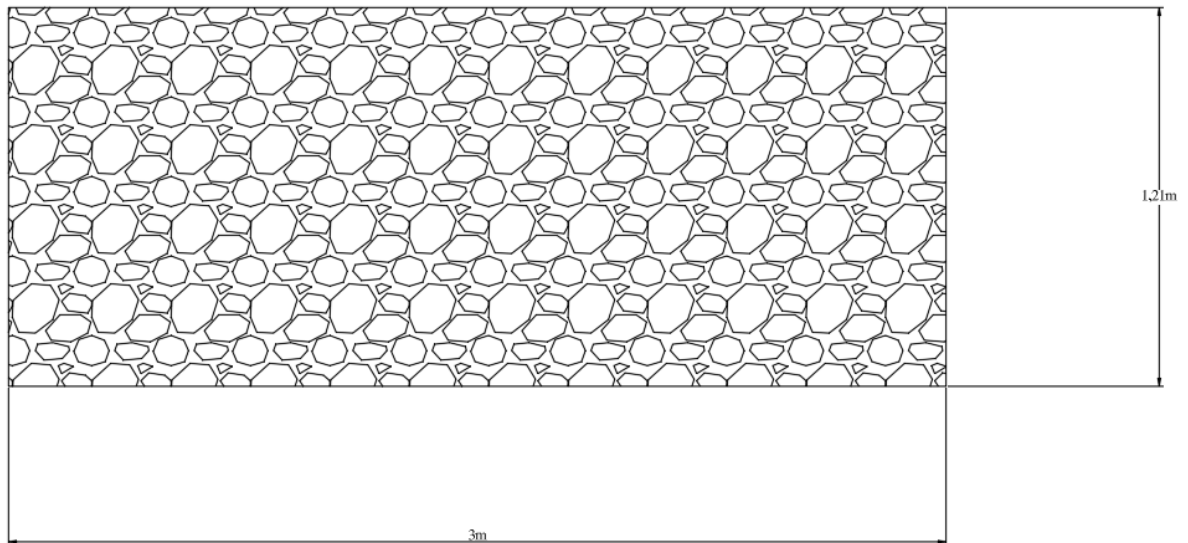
Sección de puente tipo Tablero para luz de 15m
